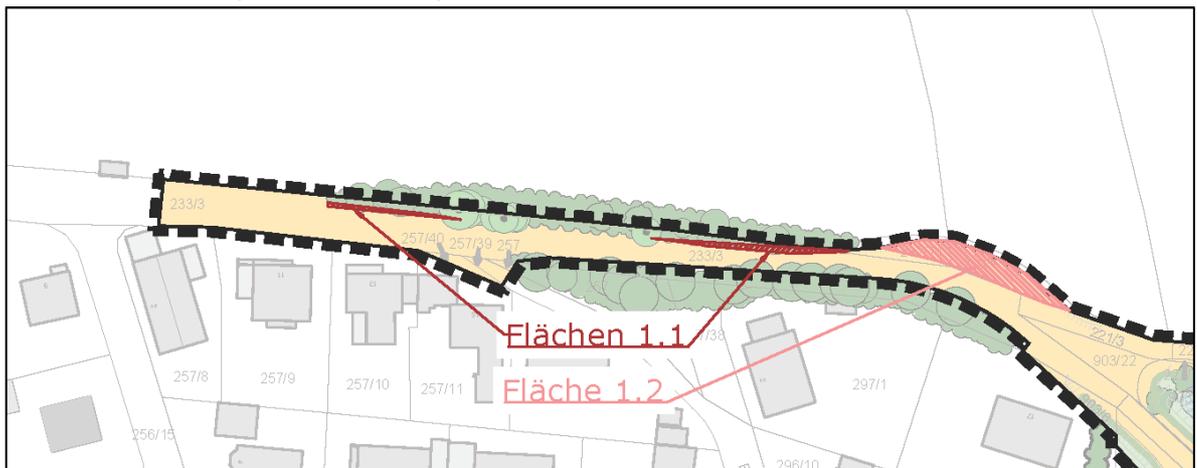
Darstellung ausgleichsrelevante Flächen; Teilbereich 1 - Zufahrt: (ohne Maßstab, hier: bereits erfolgter Straßenausbau)
